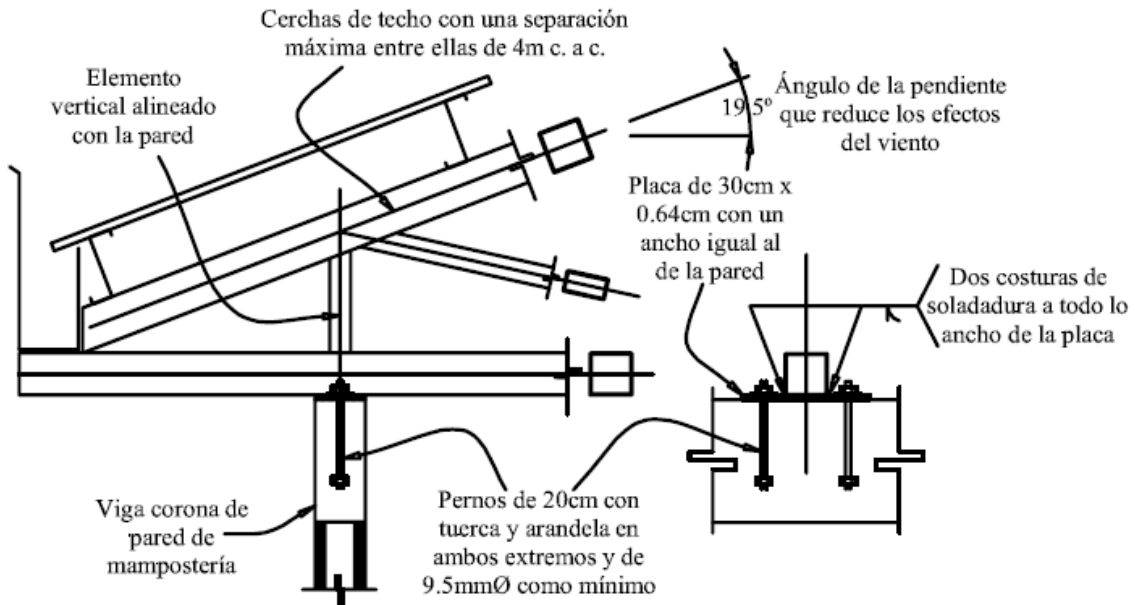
Detalle de apoyo de cercha en pared prefabricada de baldosas horizontales dos costuras de soldadura
